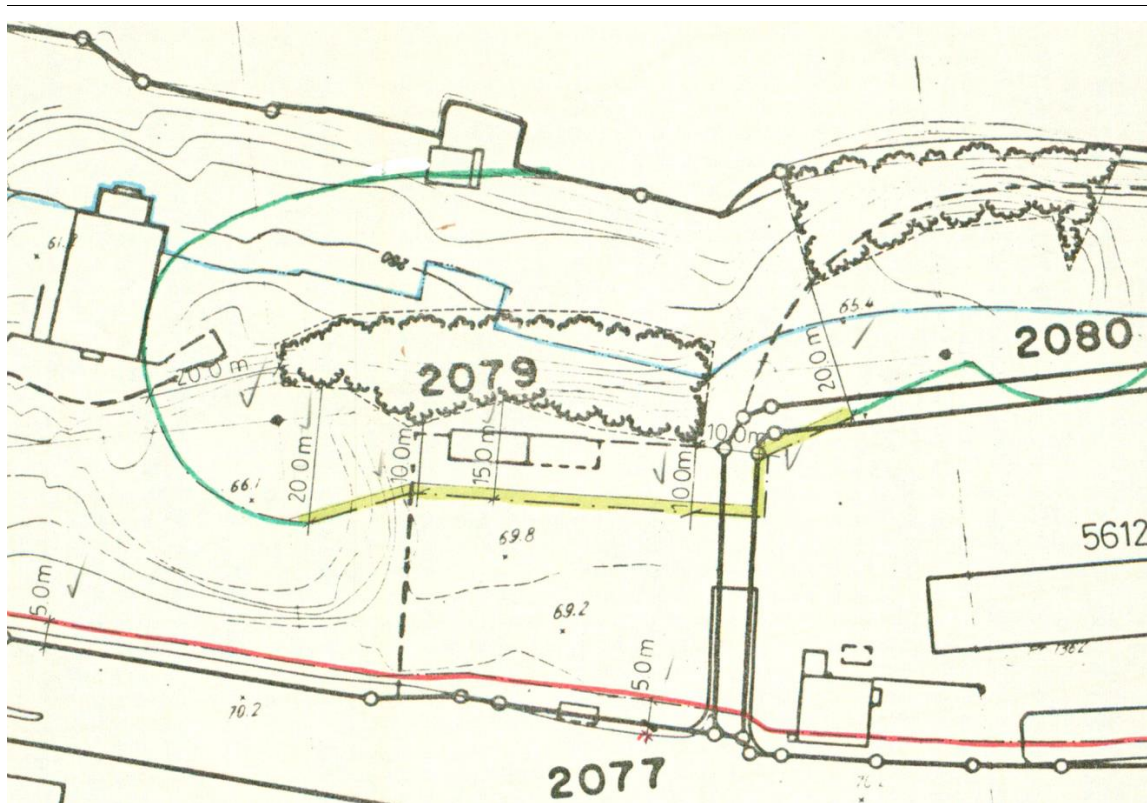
Baulinienplan Rheinlehne aus dem Jahr 1991, Ausschnitt
